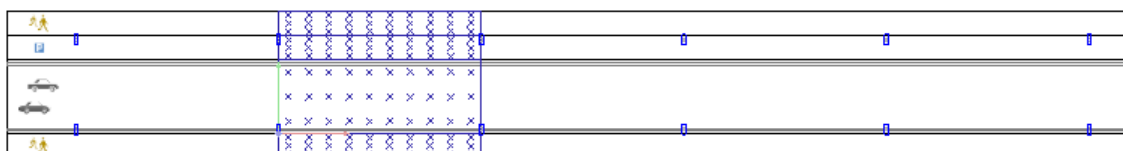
Vista de la distribución en planta de la calle Villanueva i Gascon
